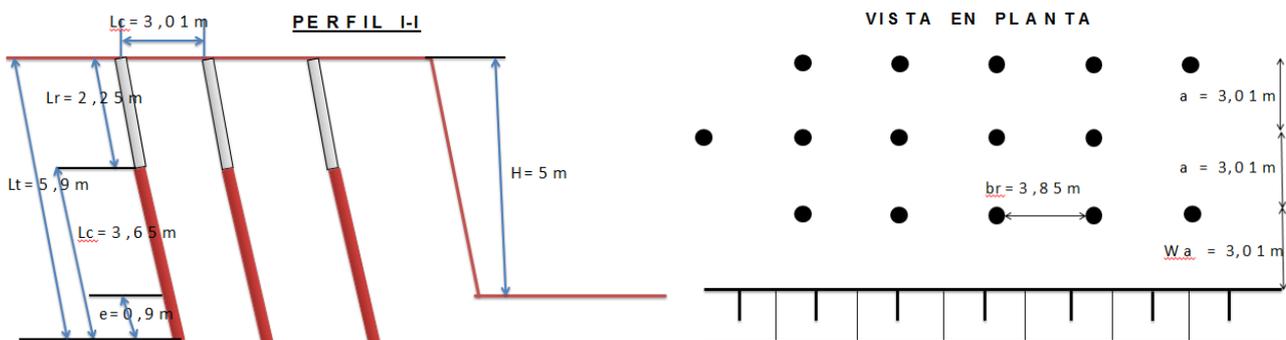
Perfil longitudinal y vista en planta del pasaporte de voladura.
